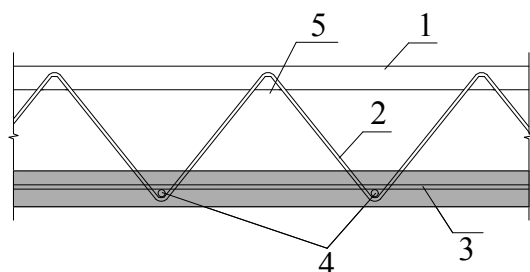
吊点位置附加横向钢筋与预制底板内钢筋位置关系示意
